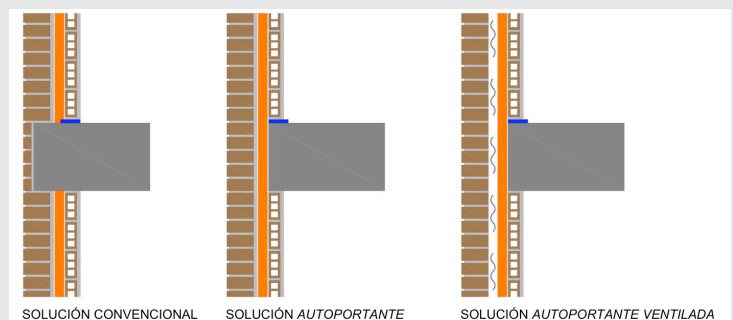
Tipos constructivos de las fachadas de ladrillo cara vista
